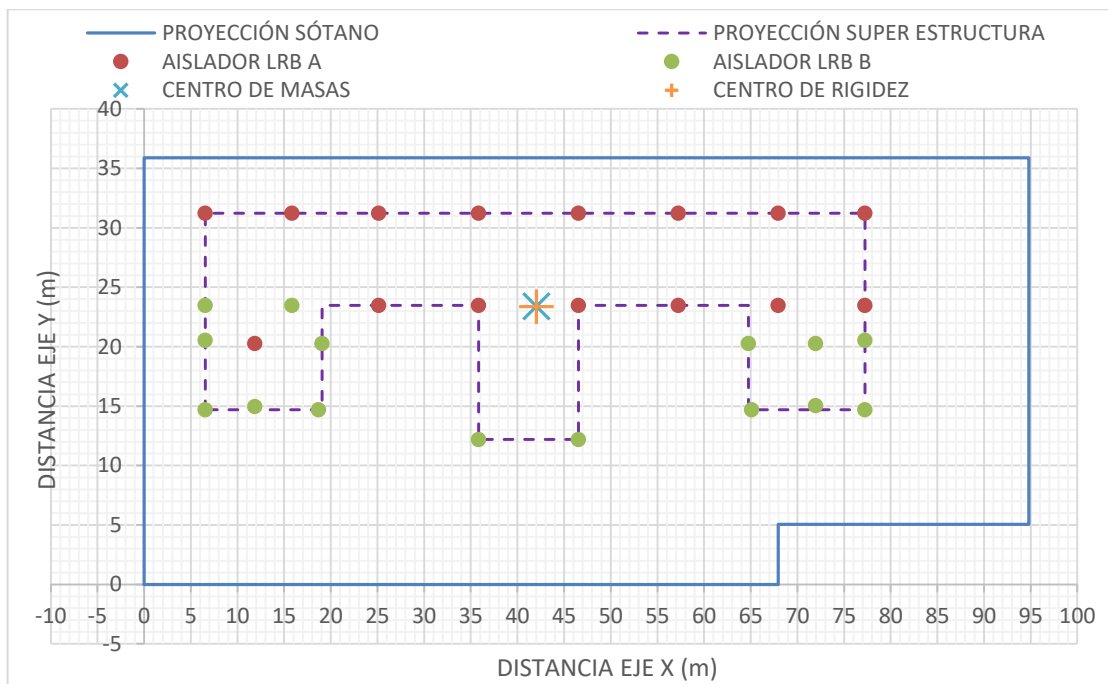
Esquema de distribución de Aisladores LRB A (Rojo) y LRB (Verde), Centro de Masa (Celeste) y Centro de Rigidez (Anaranjado).
